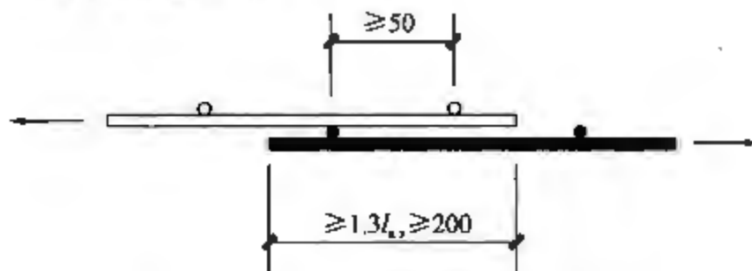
带肋钢筋焊接网搭接接头
